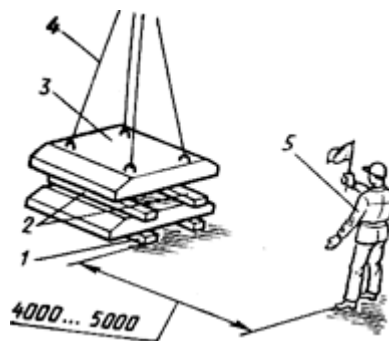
«Схема підйому збірного блоку фундаментів»:
